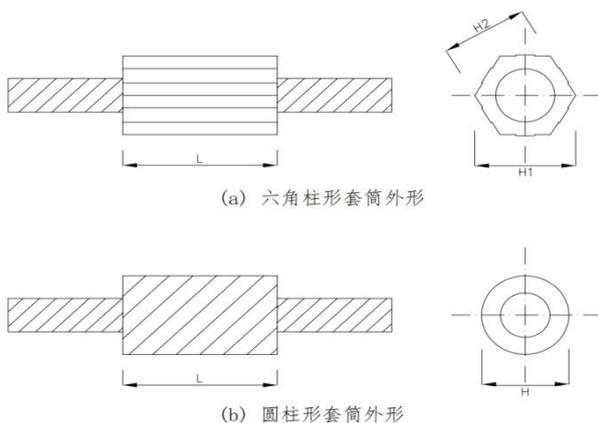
HG6/C 钢筋连接用直螺纹套筒示意图
